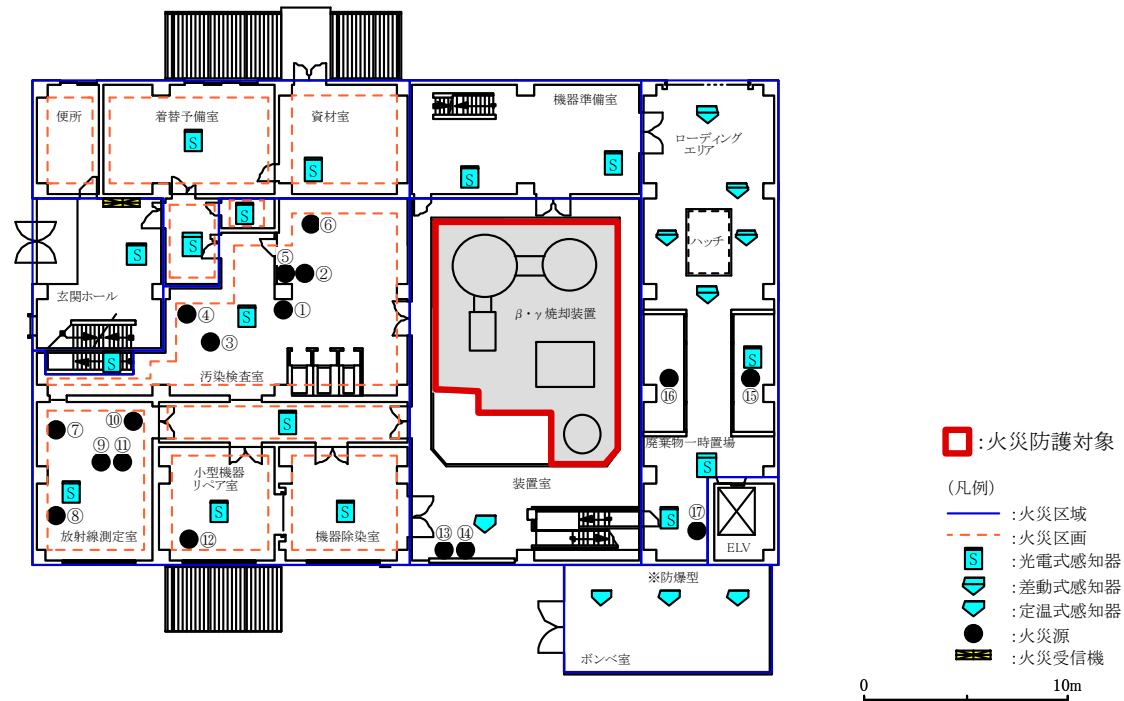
β・γ 固体処理棟Ⅱ (β・γ 一時格納庫Ⅱ) 地階平面図及び可燃物配置図
